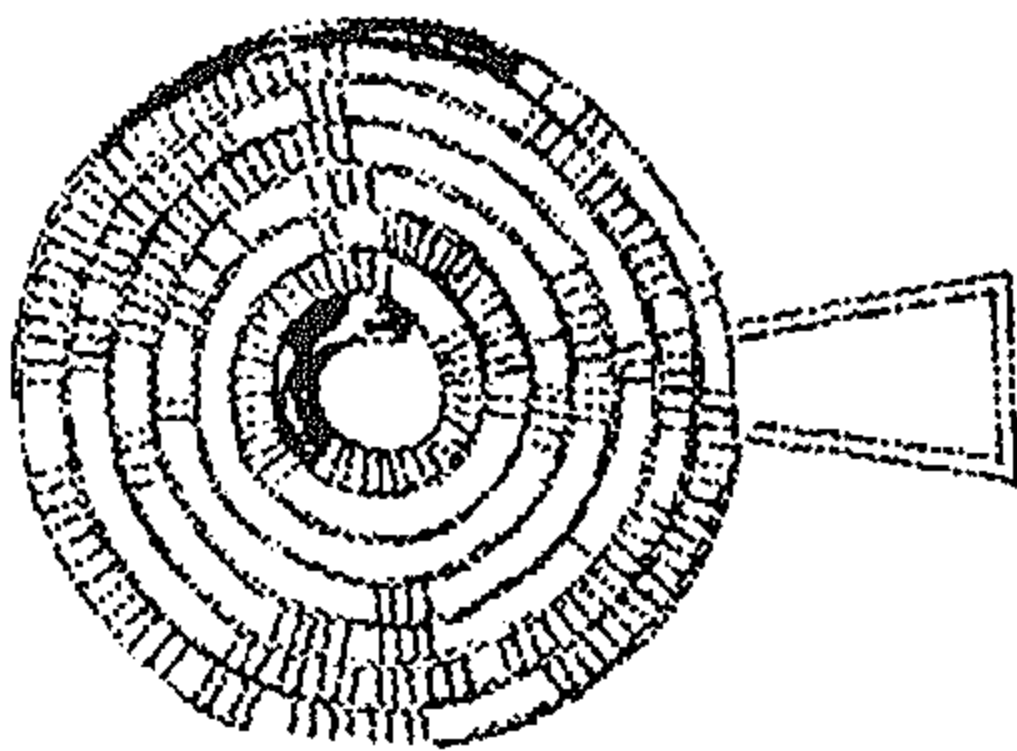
Plan (d'après de Hérault) : le plan du cercle.
